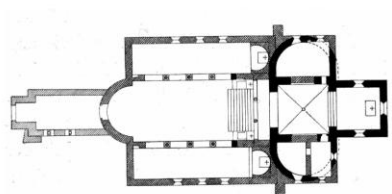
Kirche zu Reichenau-Oberzell. Grundriß.
